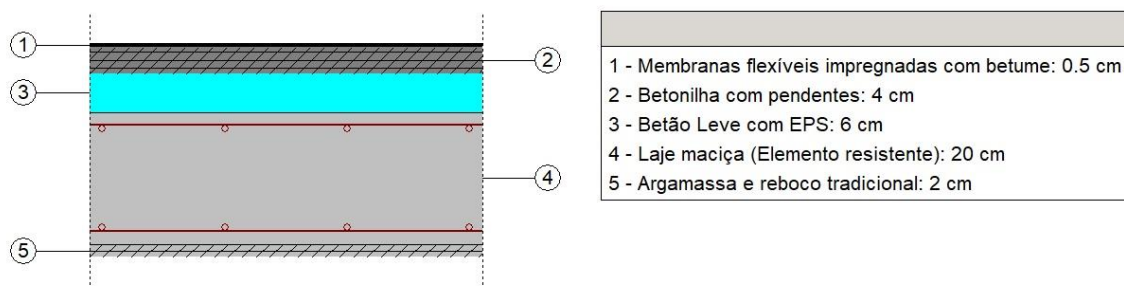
Pormenor construtivo da cobertura, numa situação tipo de melhoria
